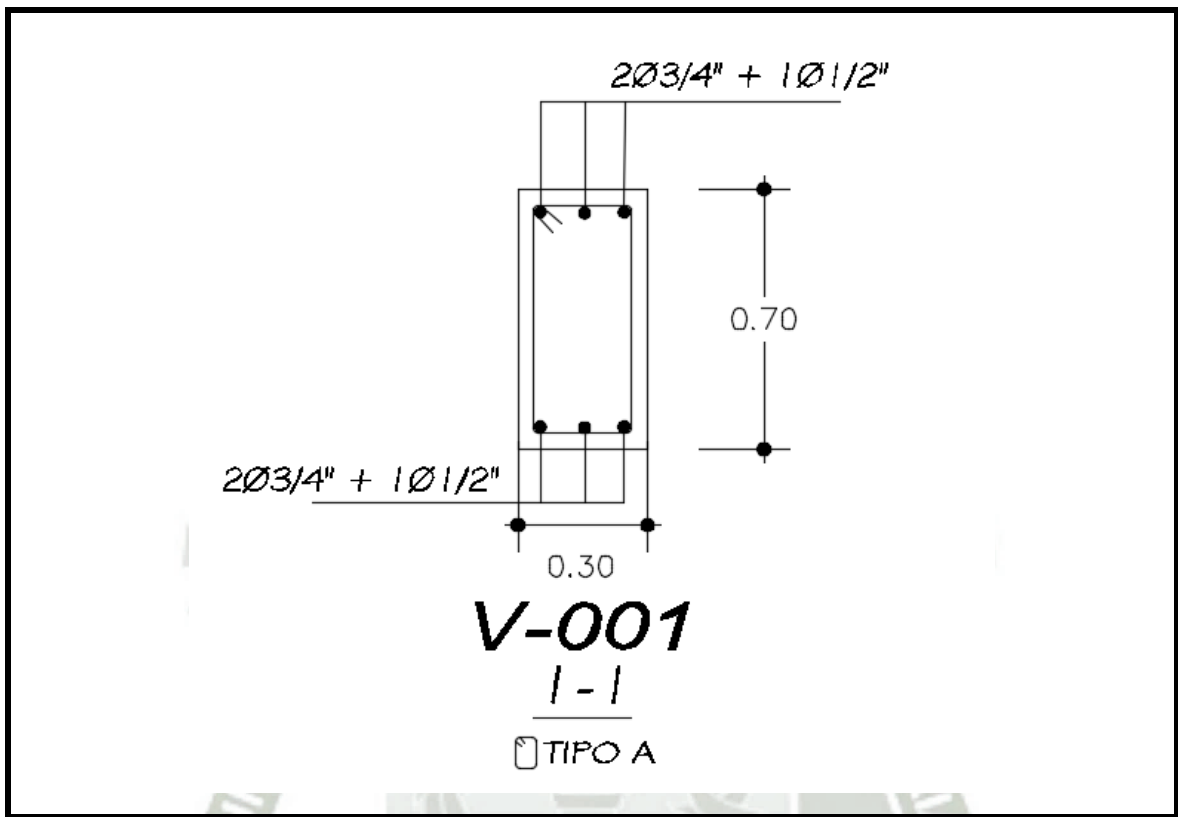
Corte Transversal de la Viga V-001.
